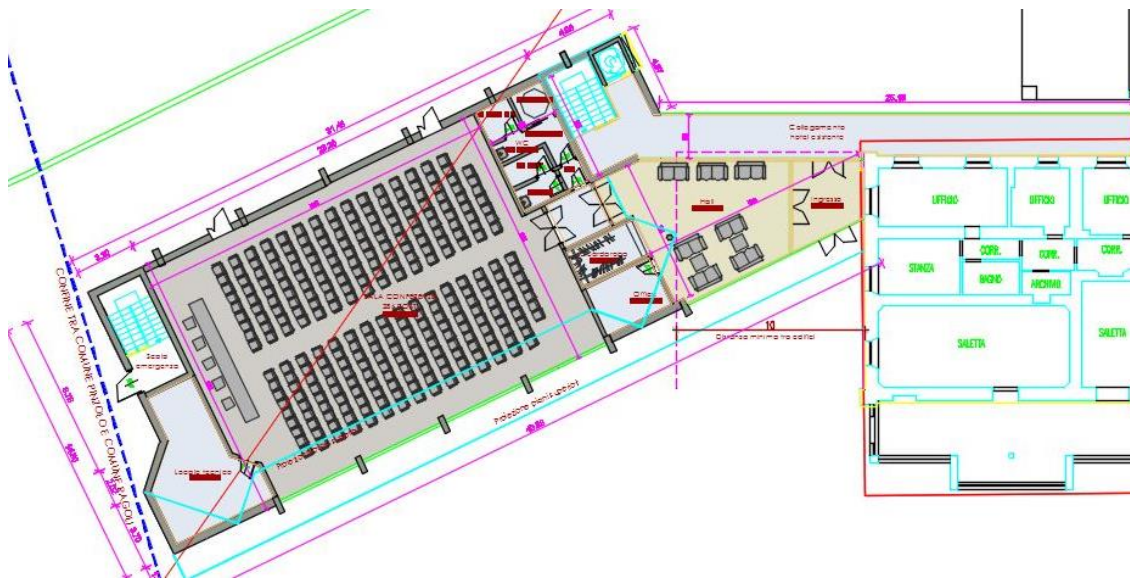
Progetto ampliamento Golf Hotel -particolare area nuova costruzione-
